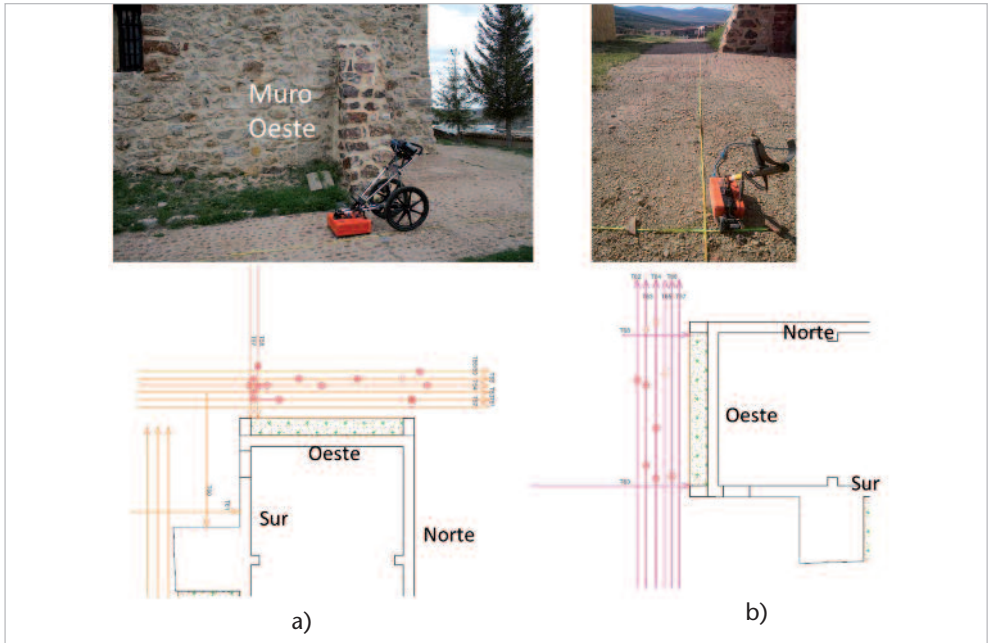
Imágenes y croquis de planta con a) 270 MHz & b) 900 MHz.
